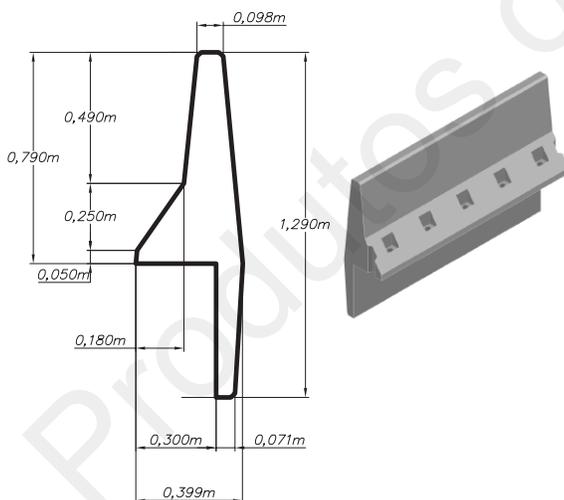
Sección y perspectiva de las barreras de concreto laterales
